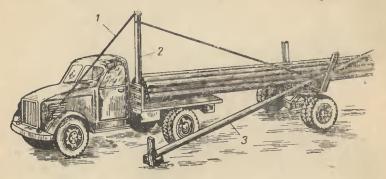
Установка опоры автомащиной. 1 - трос; 2 - стойка; 3 - опора.
